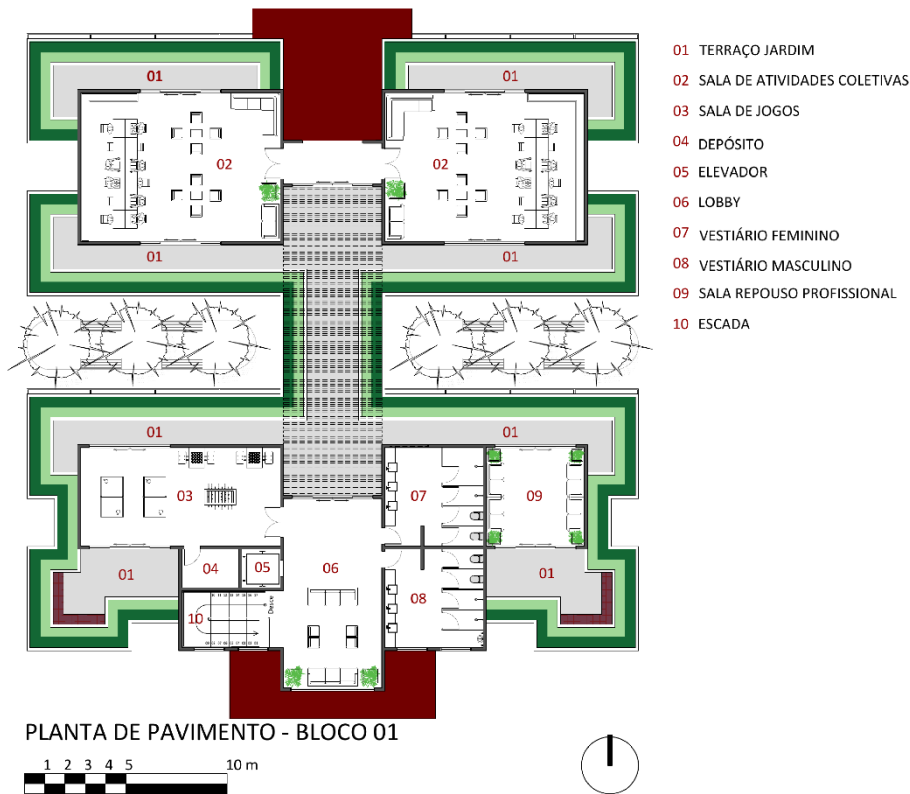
PLANTA DE PAVIMENTO DO BLOCO 01. FONTE: AUTORAL.
